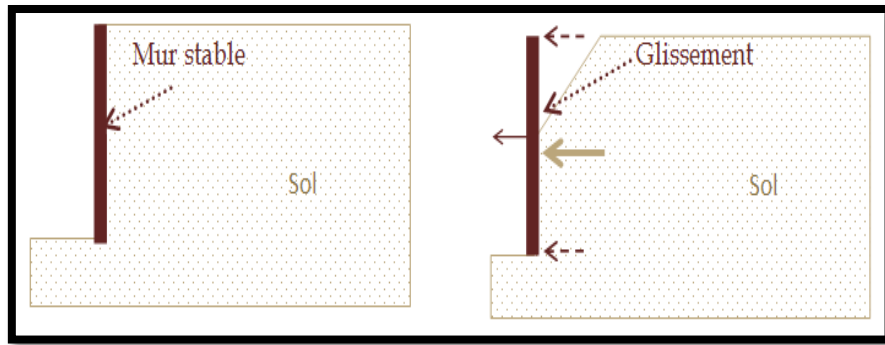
Stabilité au glissement d'un mur de soutènement [3].
